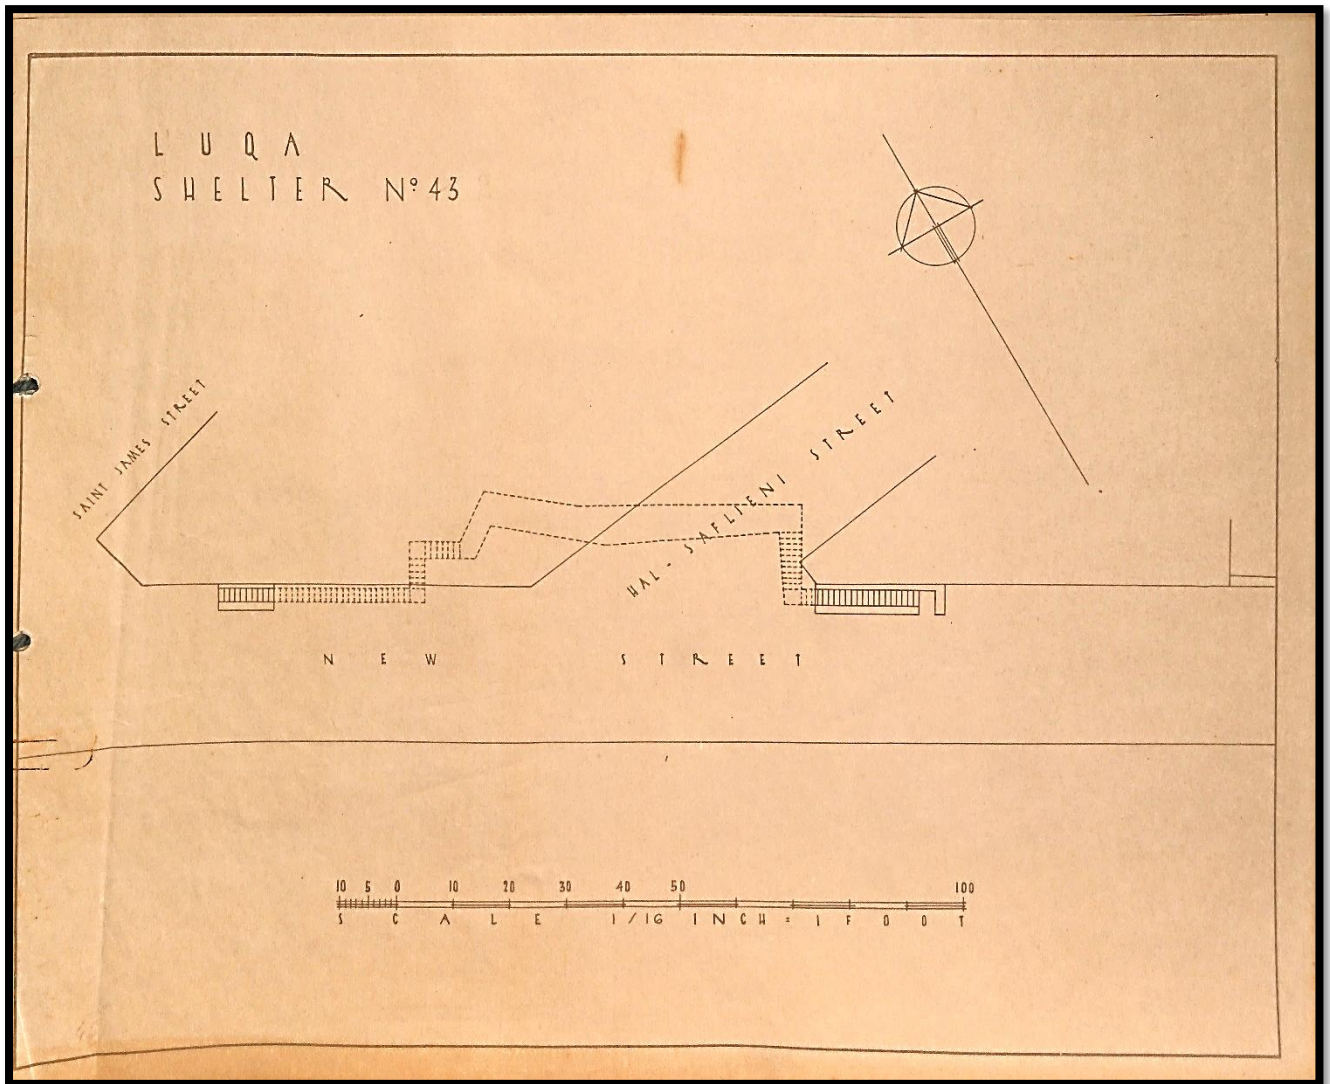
Planta do Abrigo nº43 "New Street – Hal-Saffieni Street – Saint James Street."
